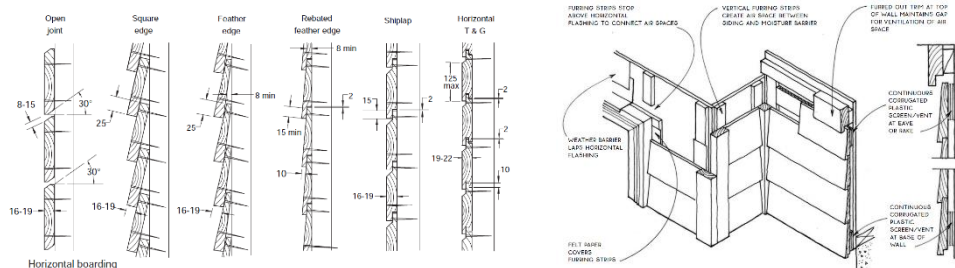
Tipos de acabamentos exteriores com perfis horizontais (TRADA, 2008) e exemplo de encontro de fachadas com caixa de ar (Thalon, 2009).
